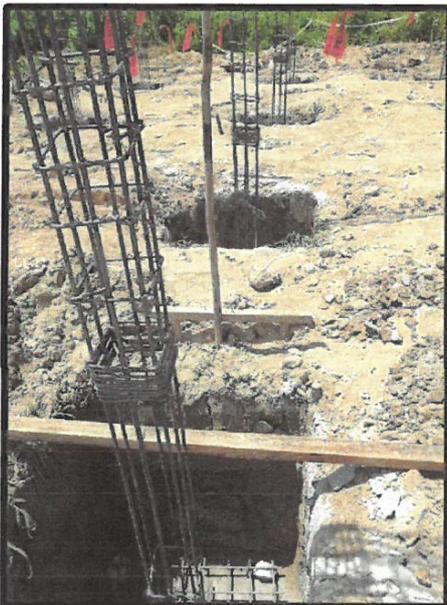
ACERO EN ZAPATA Z-1 Y COLUMNA C-1 EN MODULO 1 EJE B
